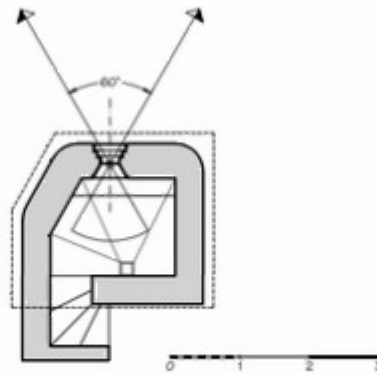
Půdorys LO vz. 37 typu B -90
